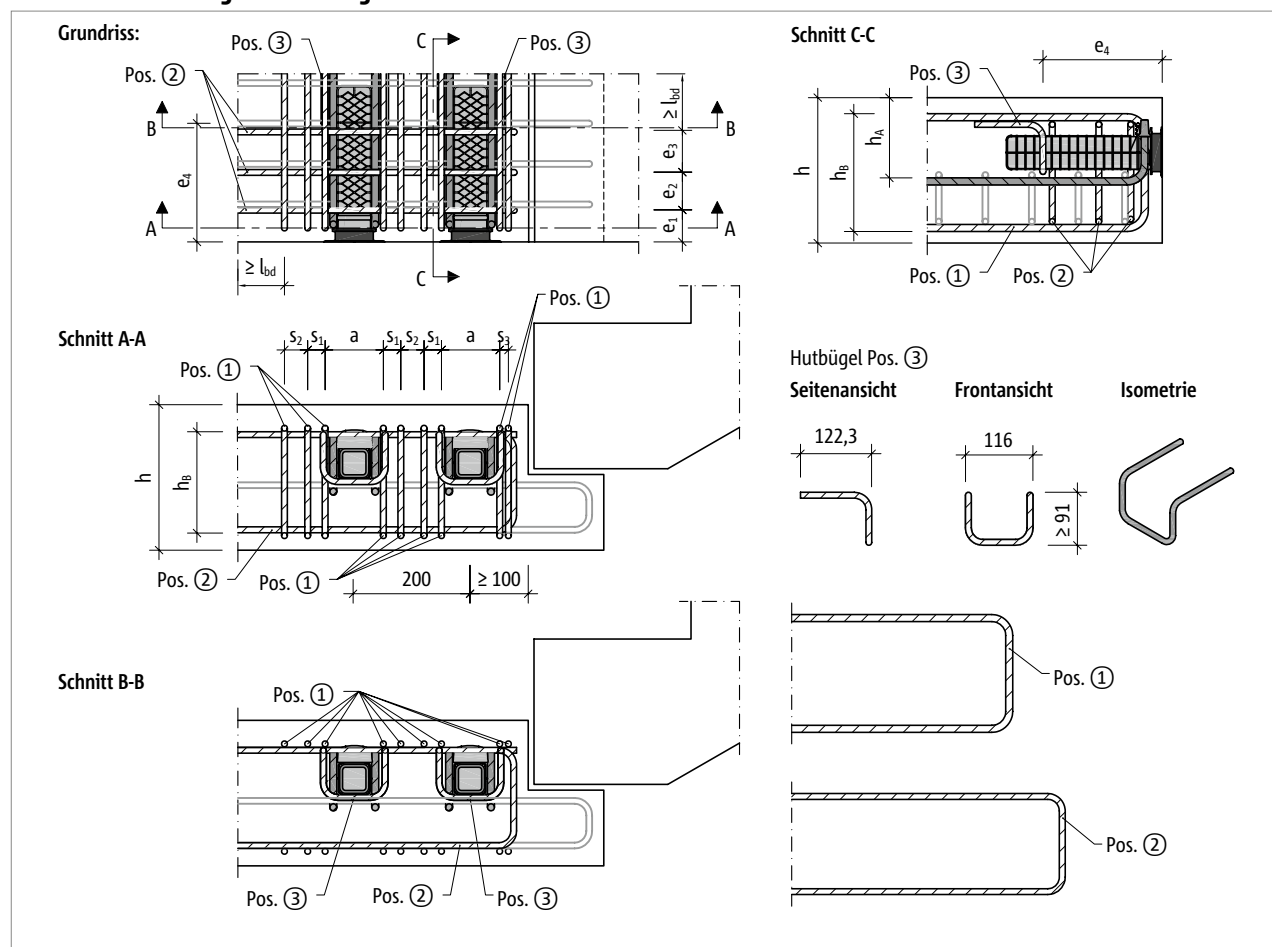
Schöck Tronsole® Typ P: Bauseitige Bewehrung für die paarweise Anordnung
